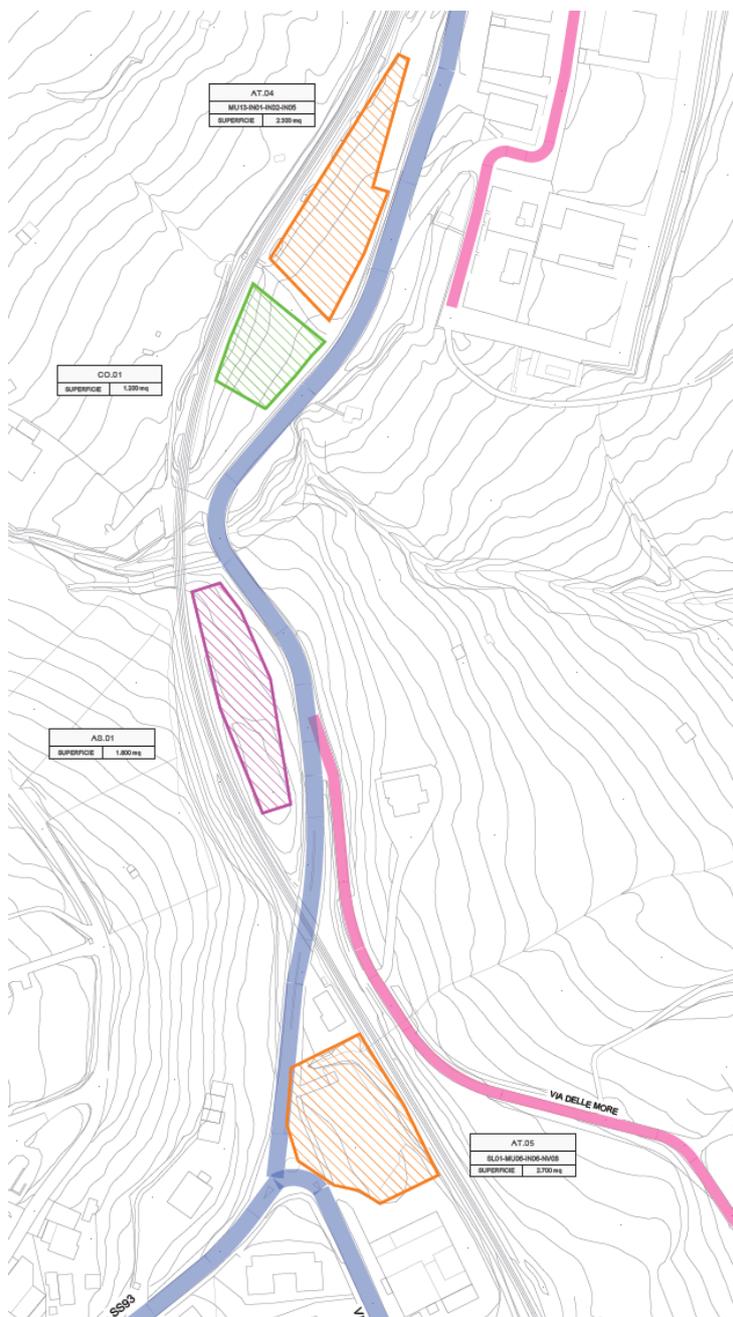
Aree di cantiere definite nel progetto di cantierizzazione del PE
